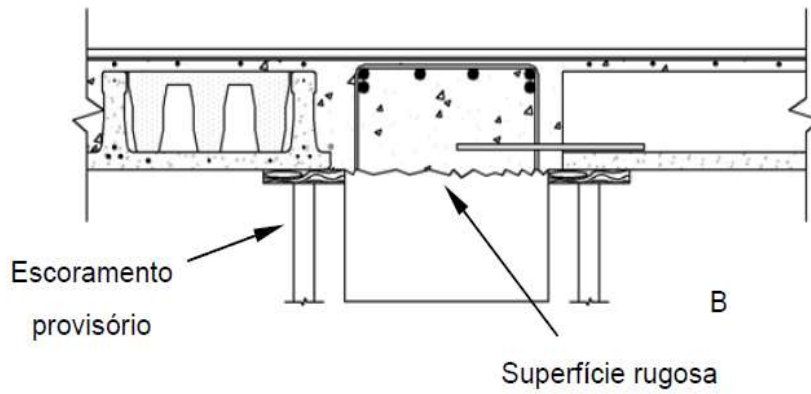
Ligação pré-laje com viga "I" (Albarran, 2008)
